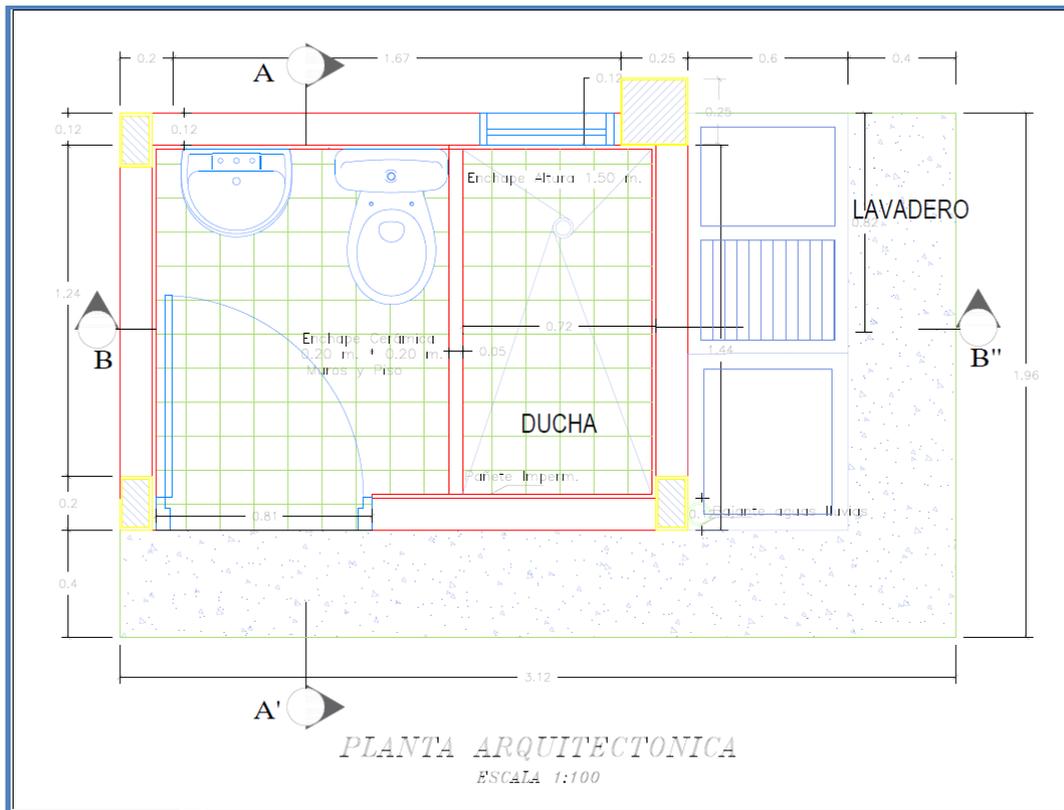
Planta Arquitectónica Unidad Sanitaria (Fuente: MVCT)
